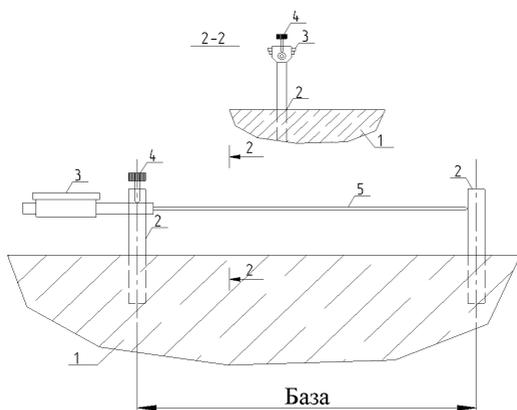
Схема установки индикатора часового типа для измерения продольных деформаций: 1 — конструкция, деформации которой измеряются; 2 — опоры, заделанные в конструкцию или приклеенные к поверхности; 3 — индикатор часового типа, закрепленный на опоре; 4 — зажимный винт; 5 — удлинитель
